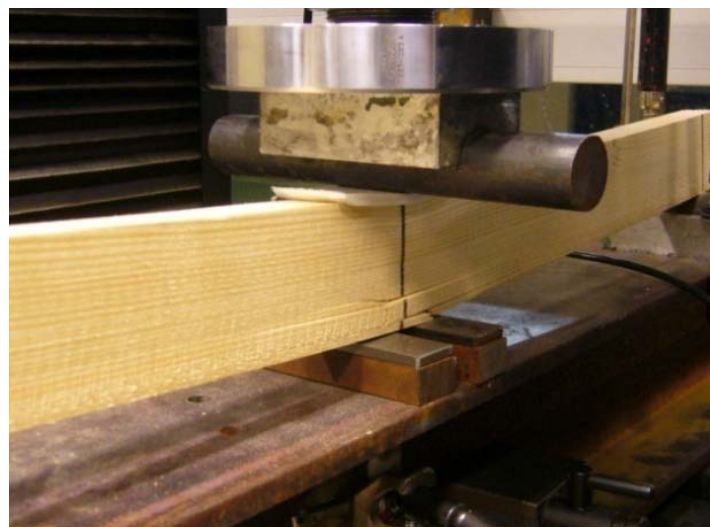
Poutre non renforcée. Rupture en traction.
